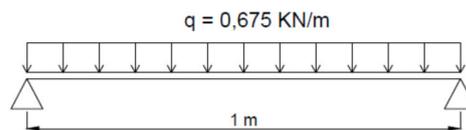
Viga teórica para el cálculo del tablero apoyado sobre las vigas transversales
